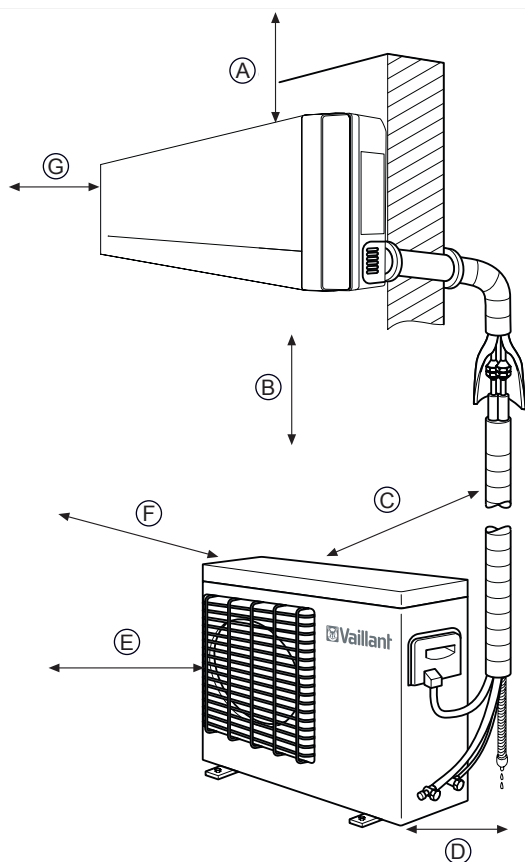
Schema generale di installazione e distanze di montaggio minime.
